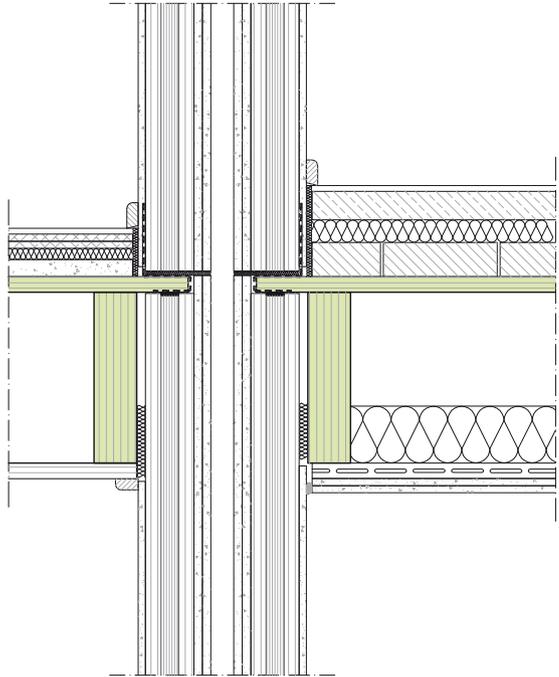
DETAIL: DACHANSCHLUSS GEBÄUDETRENNWAND
